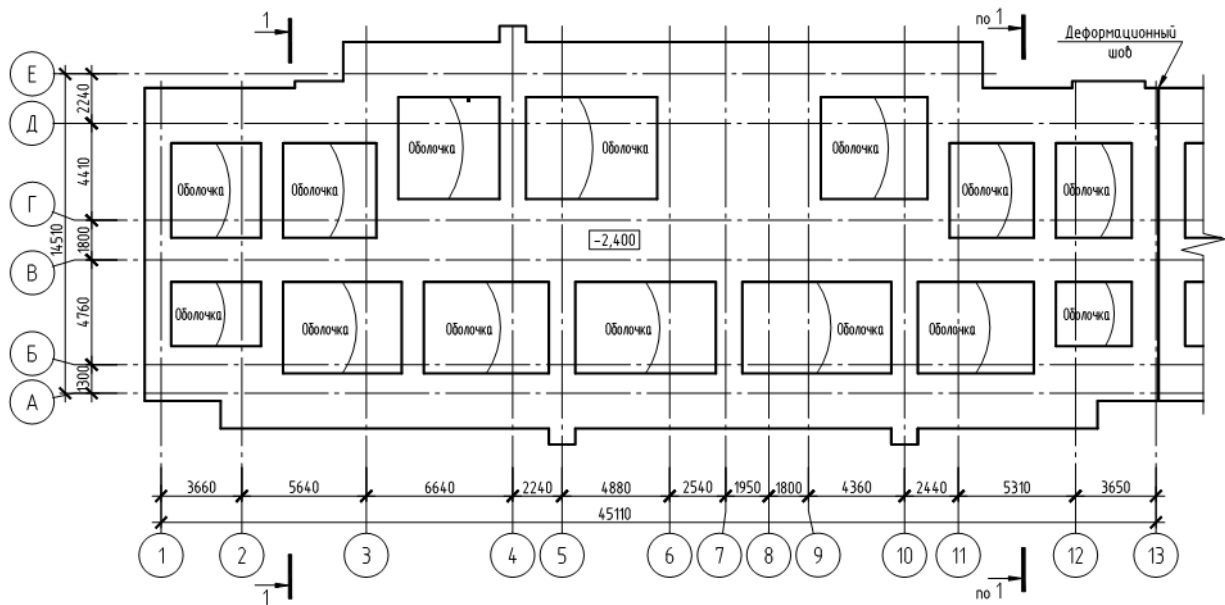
План плитно-оболочечного фундамента под первую секцию ГП-8.
